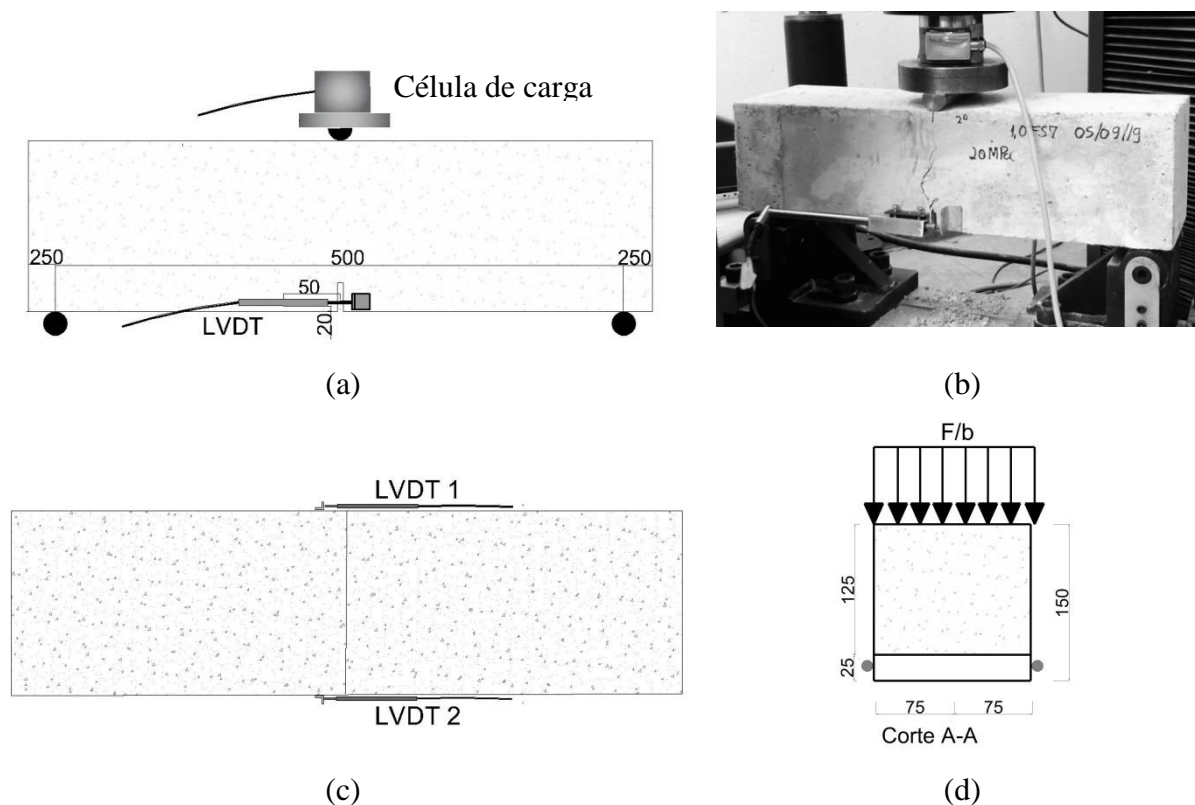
Ensaio de flexão a três pontos: (a) vista lateral do setup do ensaio (b) execução do ensaio (c) vista superior do setup do ensaio e (d) corte na região central do ensaio (região do entalhe). Medidas em milímetros.
